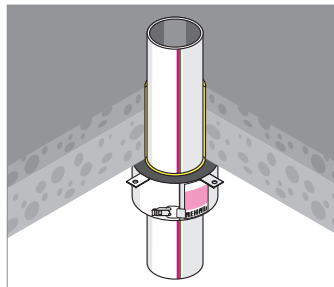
Монтаж противопожарной манжеты на перекрытии
